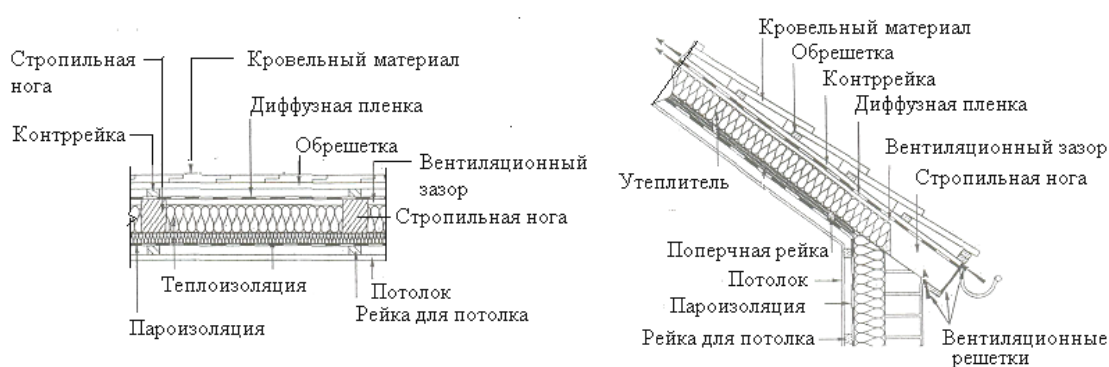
Структура горизонтальной и наклонной кровли мансардных надстроек
